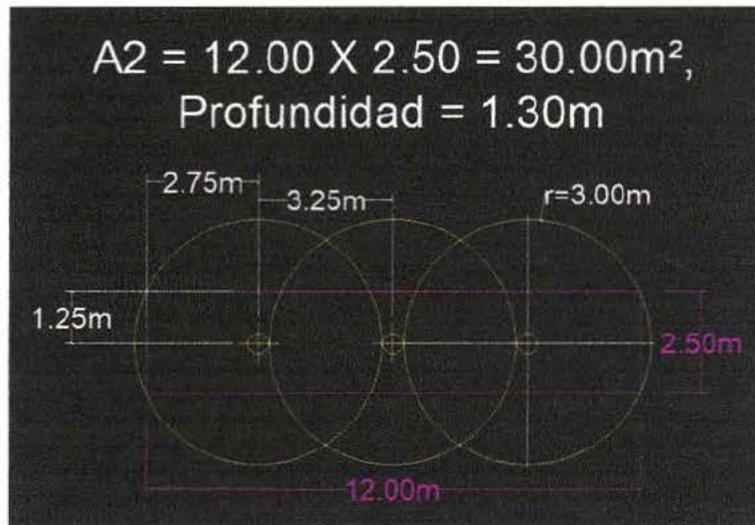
Vista de planta, distribución de los pozos para airear el área impactada A-2.
